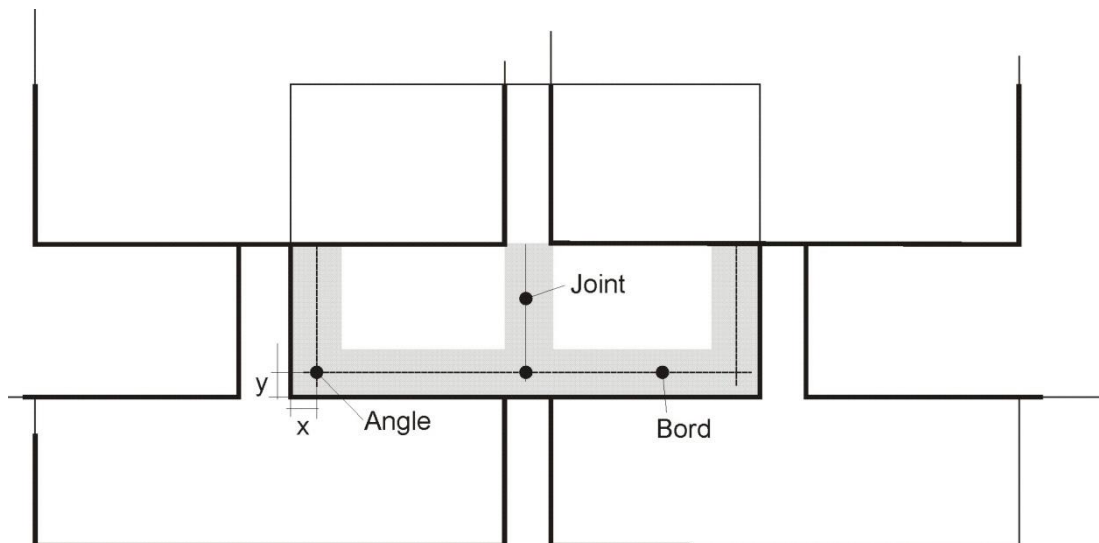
Points d'impact et angle de tir pour une plaque ou une ardoise en fibres-ciment profilée de façade avec l'axe du profil en direction verticale.
